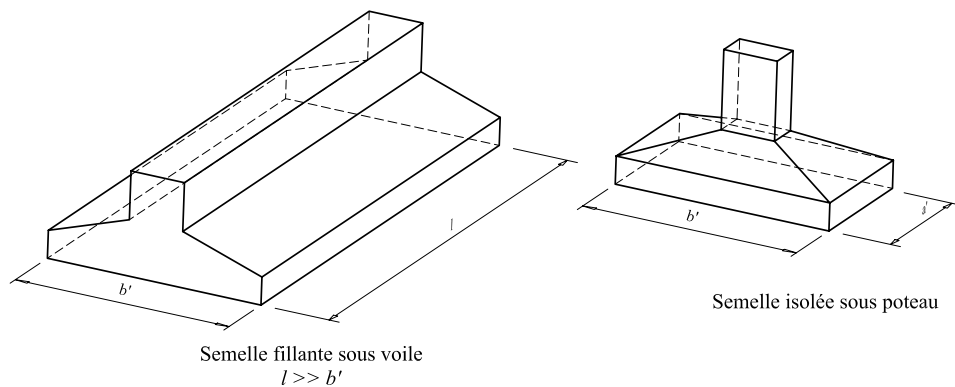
Définitions d'une semelle filante et d'une semelle isolée.
